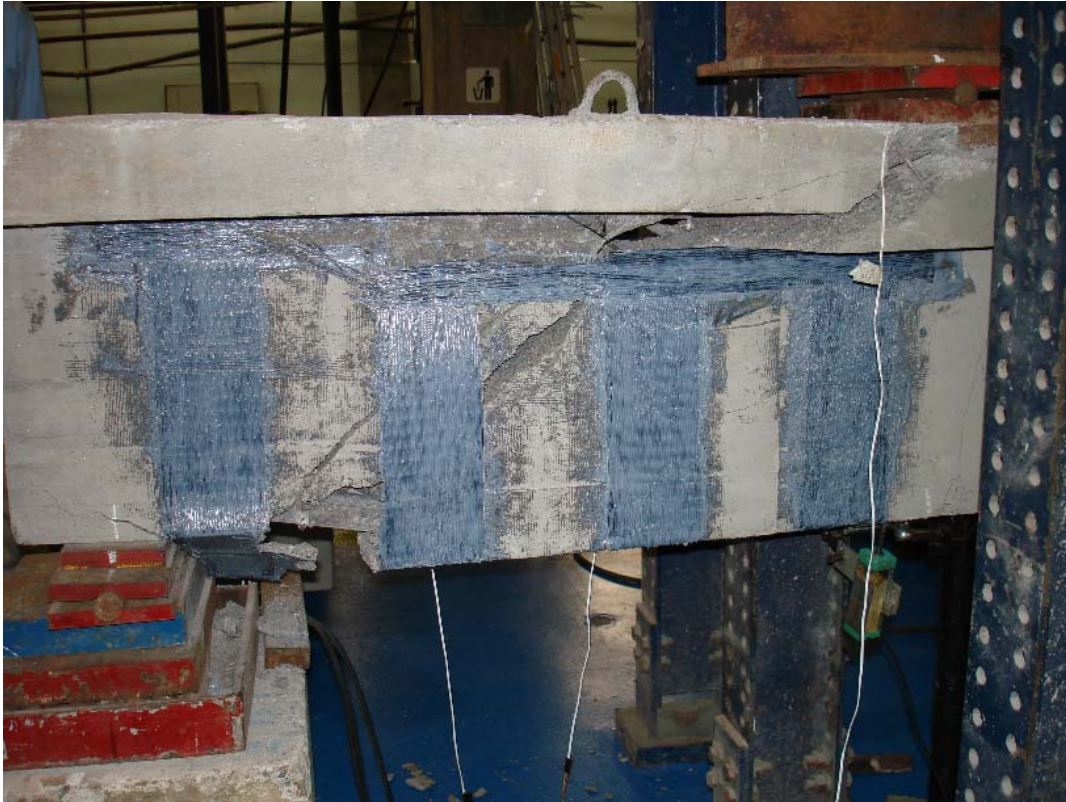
Detalhe da ruptura da viga VII-1 (1).
